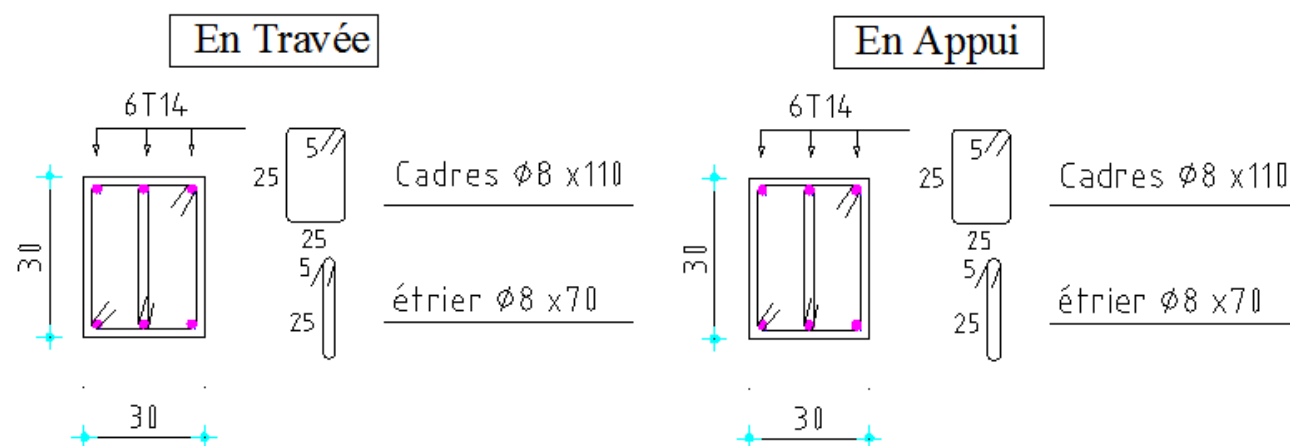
Dessin de ferrailage de la poutre secondaire
